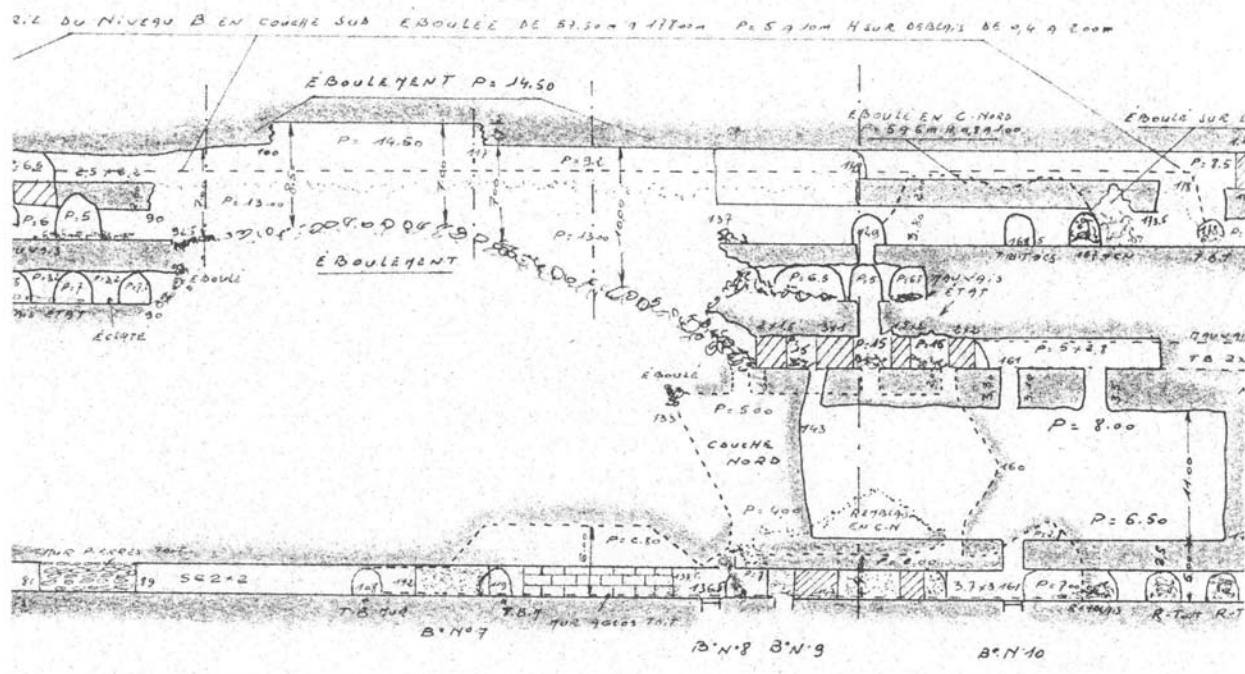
Coupe longitudinale des travaux du flanc nord dans le secteur de l'éboulement de 1918
